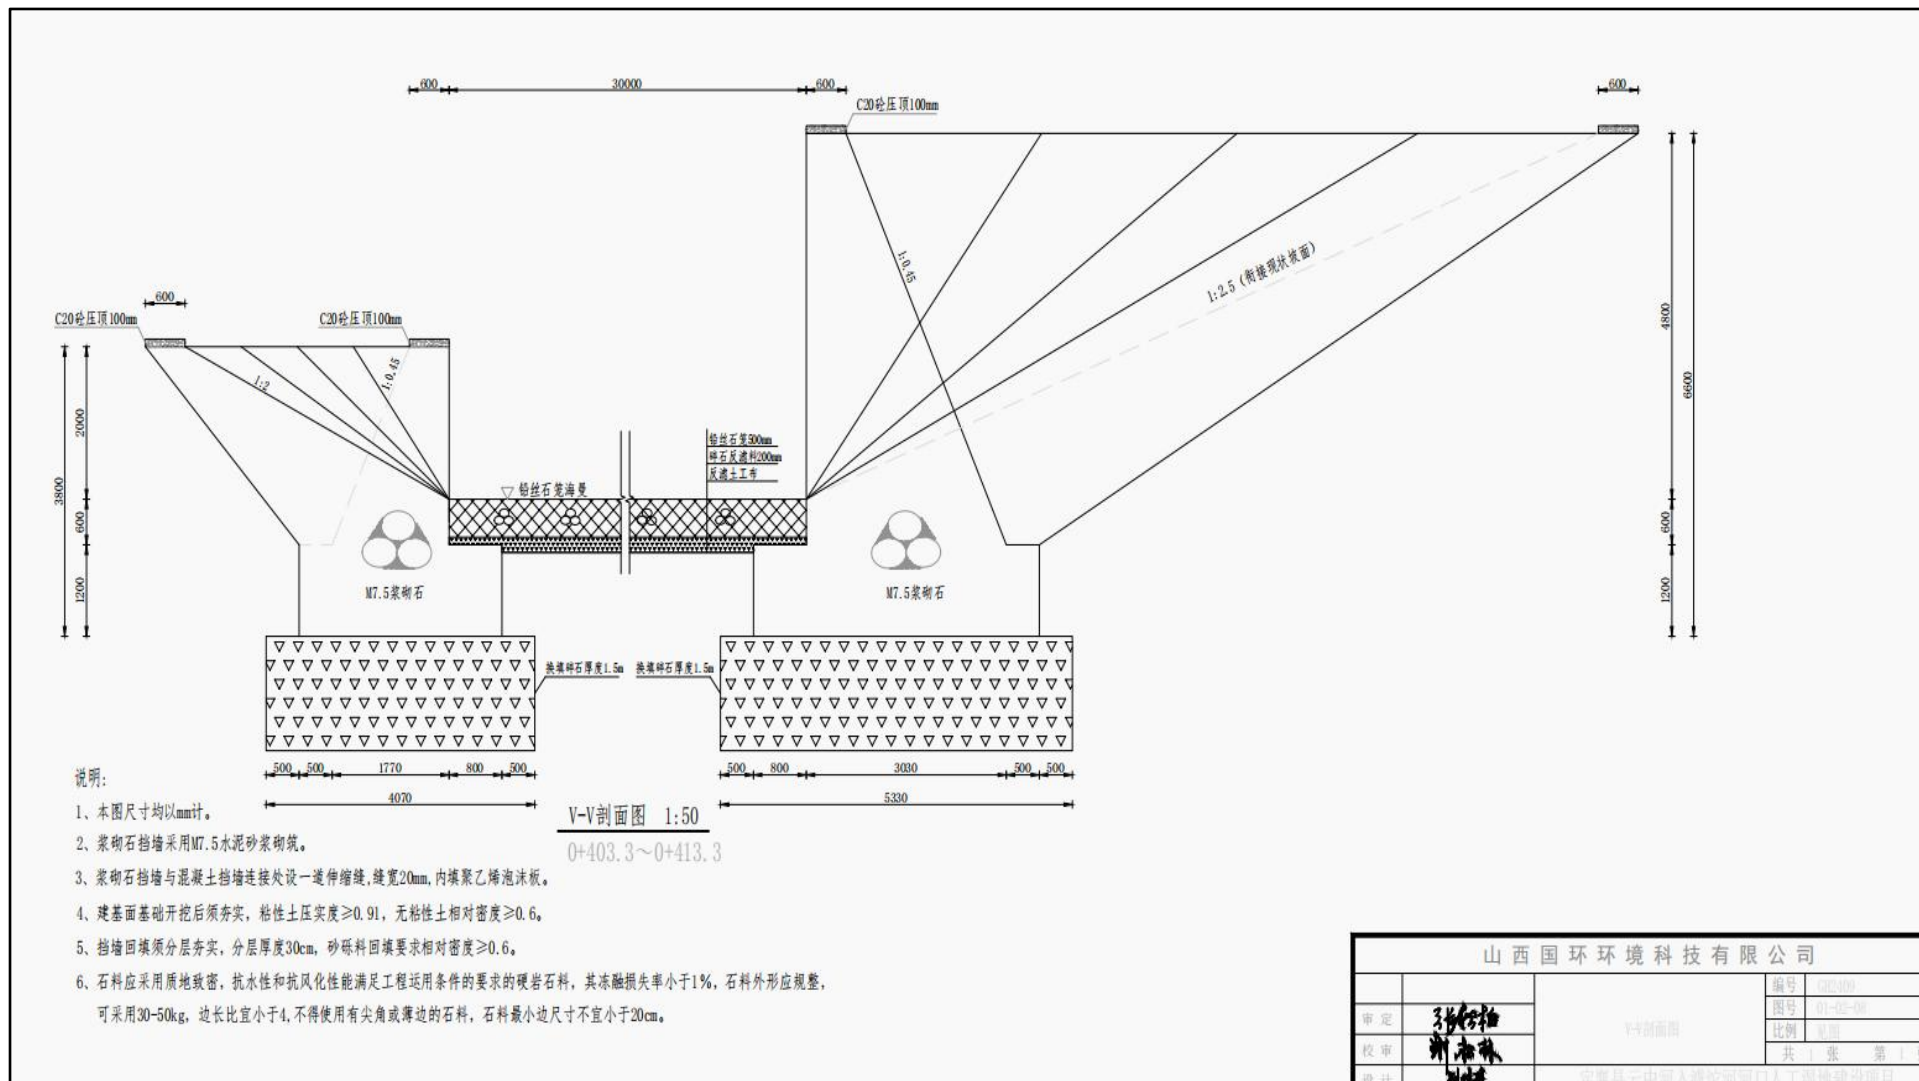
气盾坝V-V剖面图 (1: 50)
